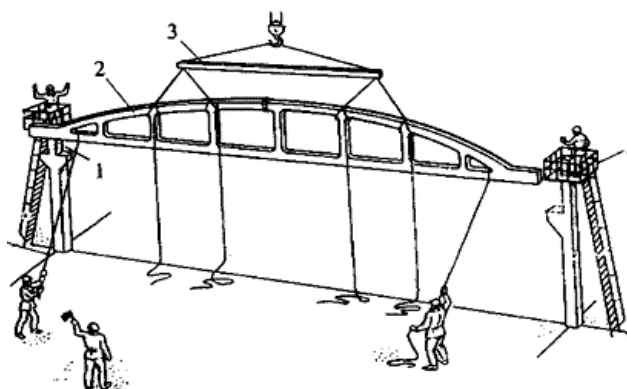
Монтаж и закрепление фермы на опорах колонны:
